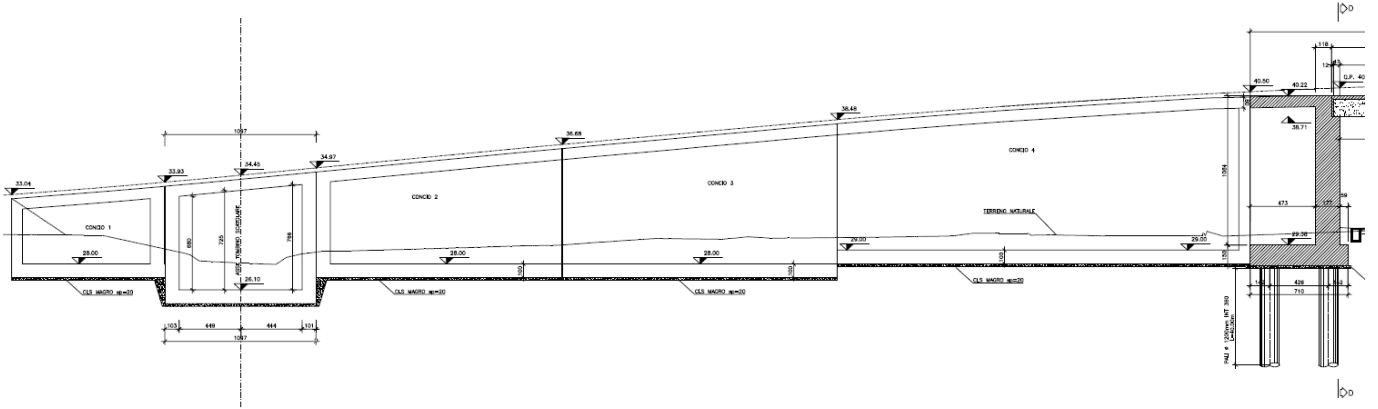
Sezione longitudinale 1 (da concio 1 a 4)
